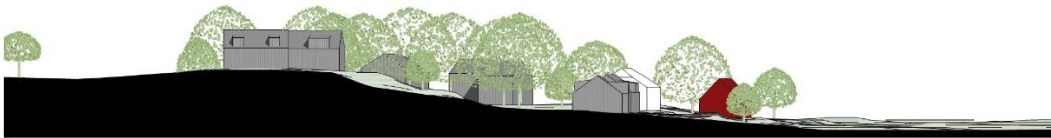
Fotomontage över möjlig ny båthall med 14 meters nockhöjd (grå volym) i planområdets nordöstra del. Byggnaden intill är cirka 6–7 meter i nock. Se figur 10 och byggnad med beteckning A för byggnadens möjliga placering. Vy från sydost. Fotomontage: Radar arkitektur, foto Tufa Marin.
